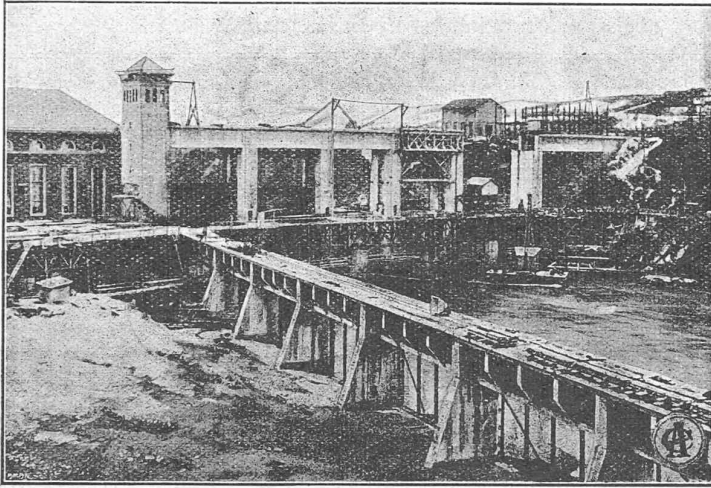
Bâtiment des turbines et barrage. Vue prise en amont, de la rive gauche.
